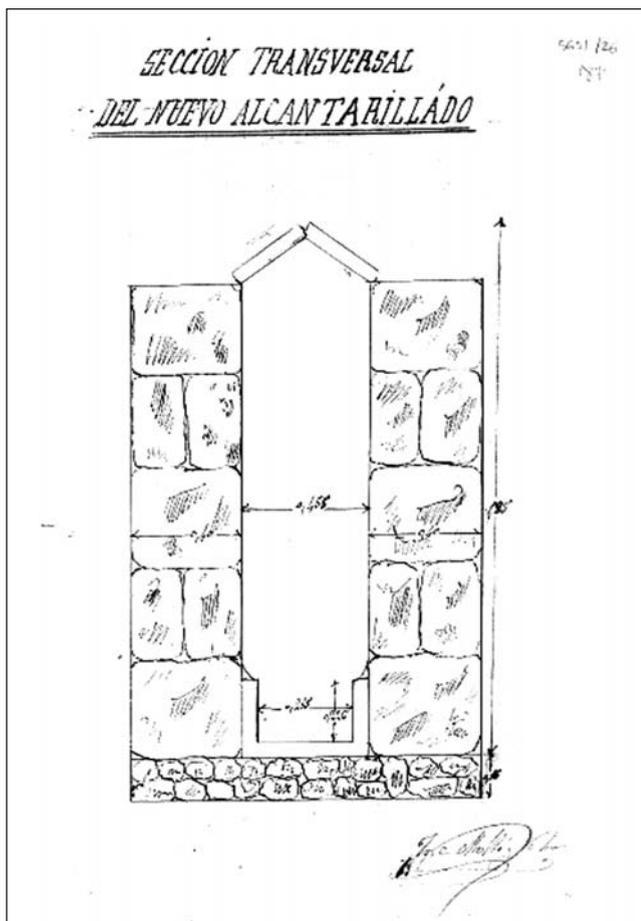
Documento del Archivo Municipal de Alcoy con sección del proyecto de alcantarillado de 1875.
